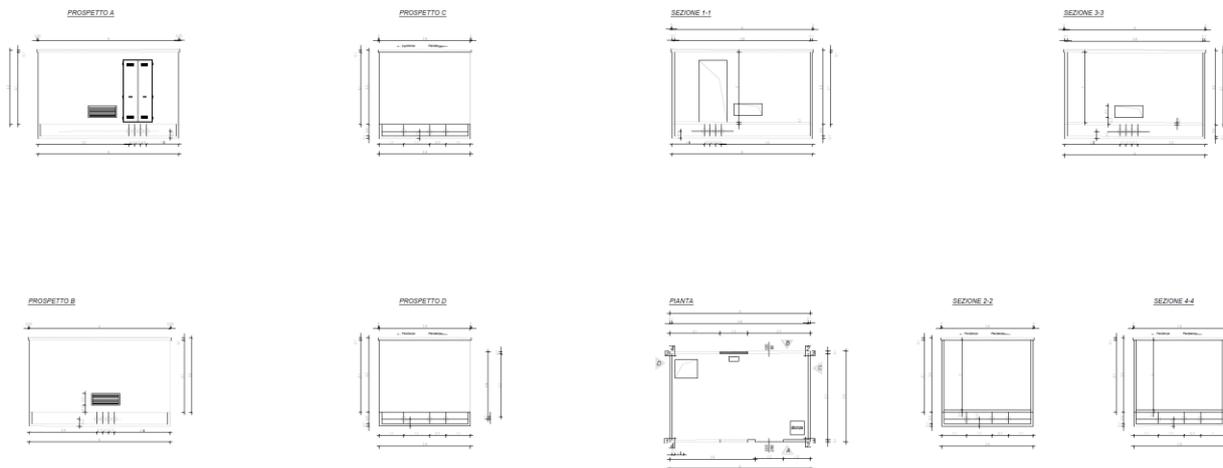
prospetti, sezione e pianta delle cabine di sottocampo.
